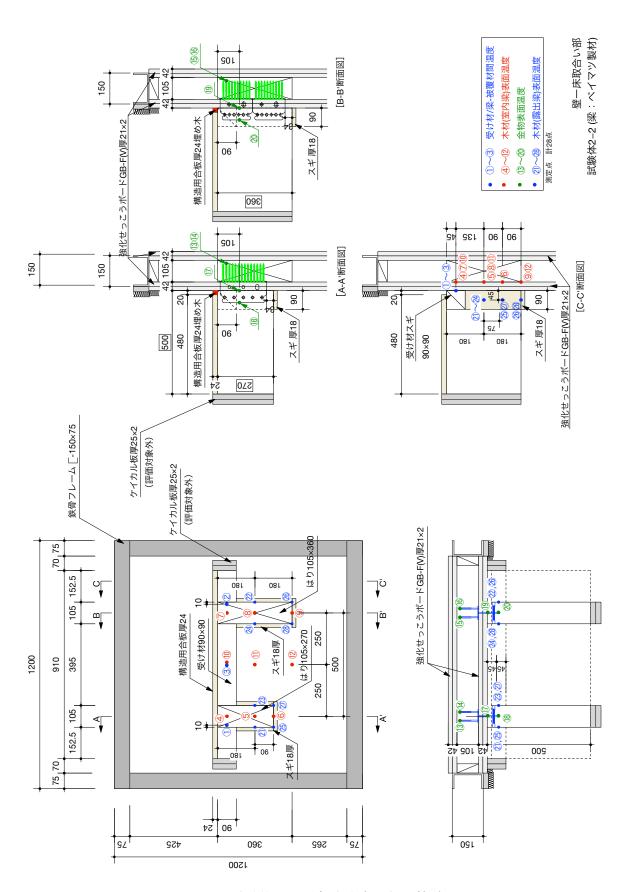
試験体 2-2 壁-床取合い部 熱電対図
